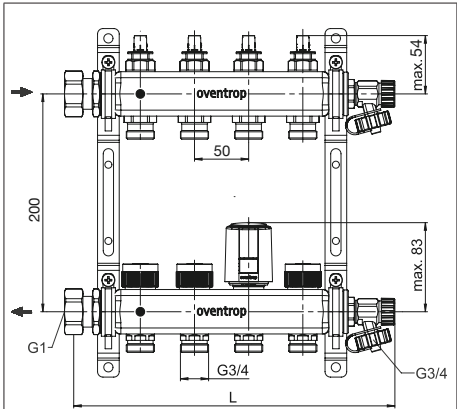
Encombrements du distributeur/collecteur pour circuits de chauffage Multidis SFQ - vue frontale
